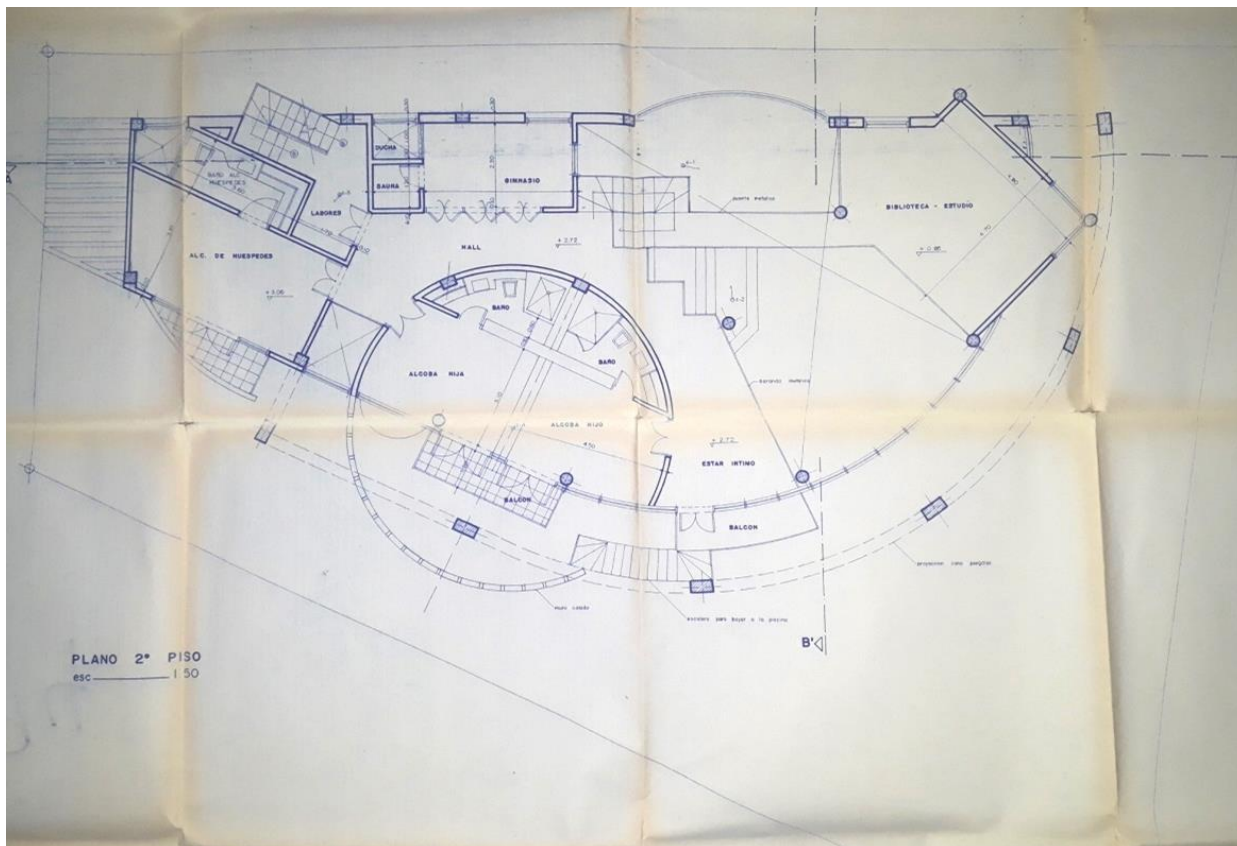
Planta arquitectónica vivienda 2 piso (1993).
